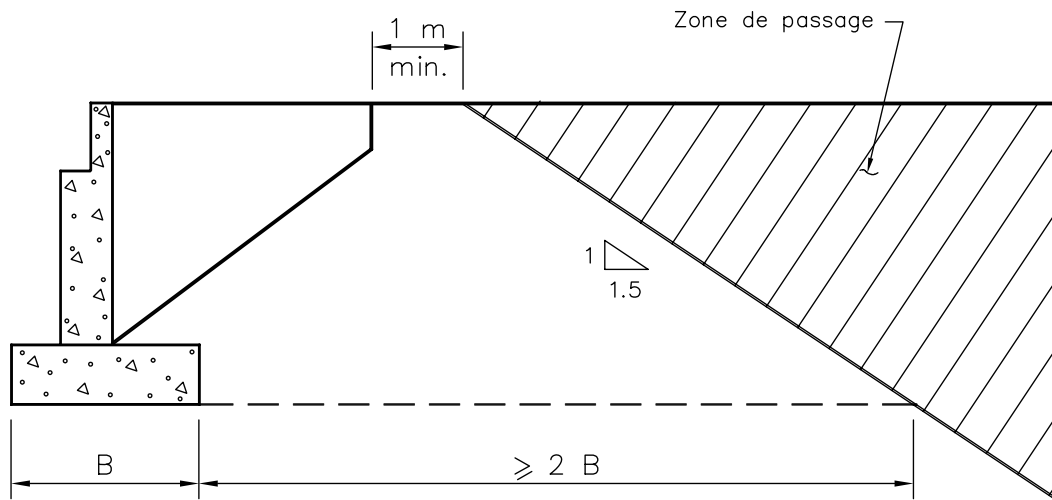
Zone de passage d'un conduit ou d'un groupe de conduits à l'arrière d'une culée
